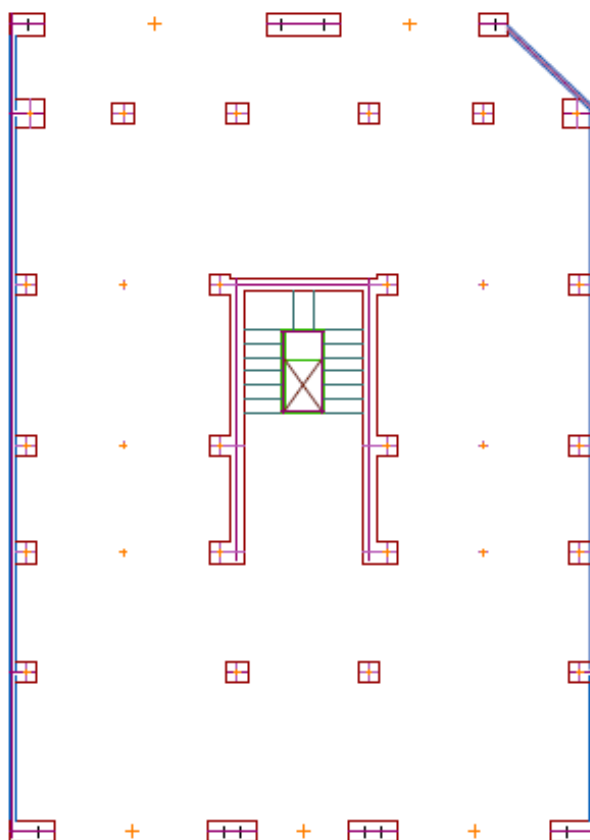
Plànol CAD de la planta baixa o tova del ED01¹
